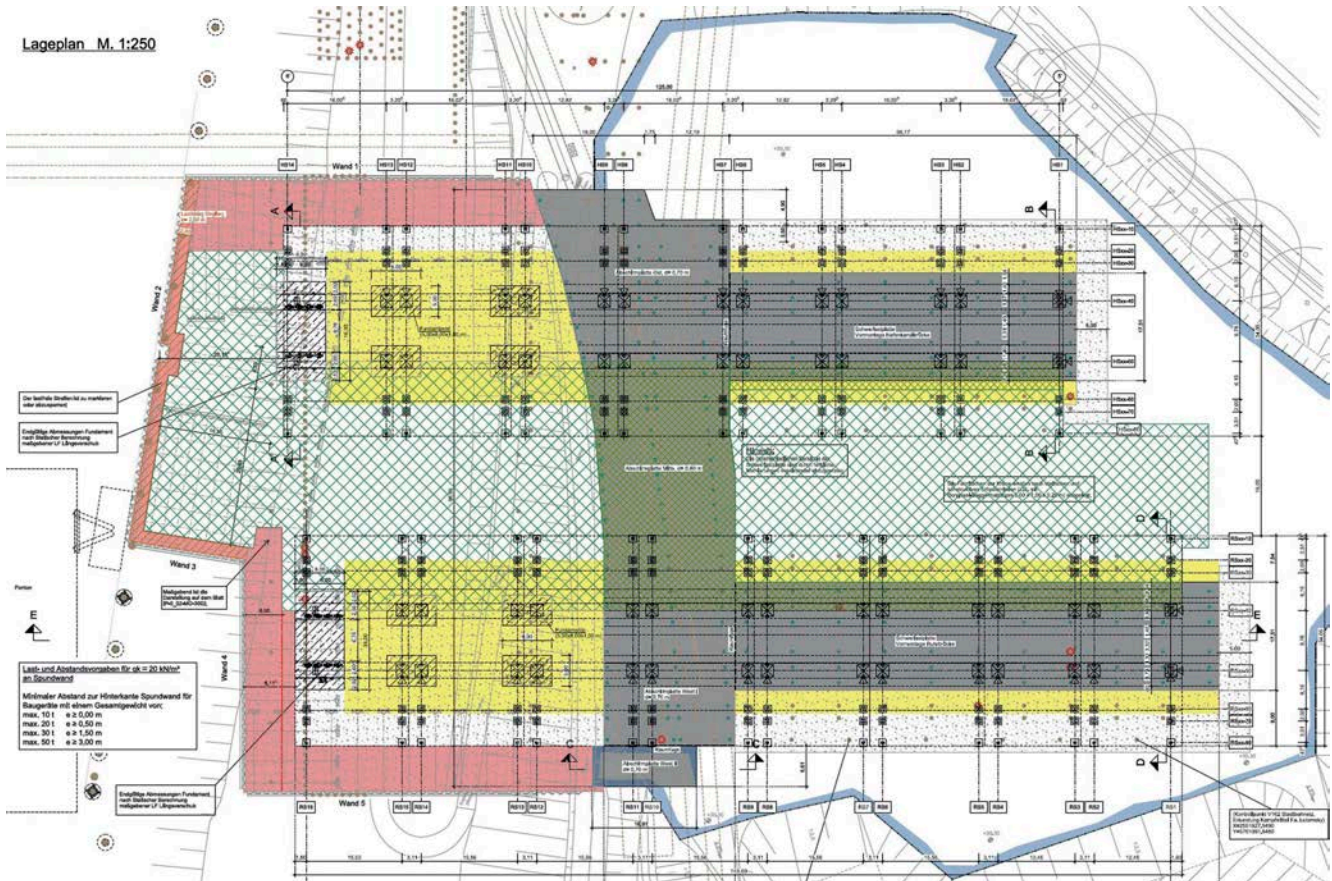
Draufsicht gesamte Vormontagefläche gemäß Ausführungsplanung inkl. Verschiebefundamente und Abschirmplatten
